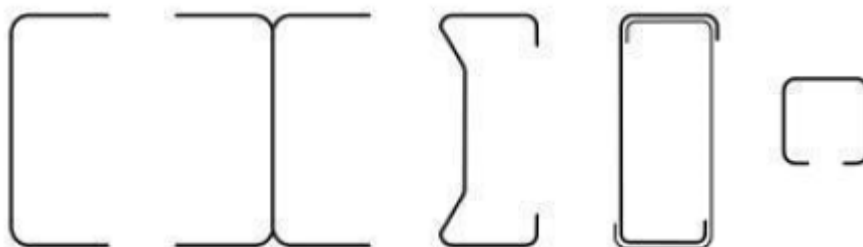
Seções transversais usuais das vigas do Porta Pallets
